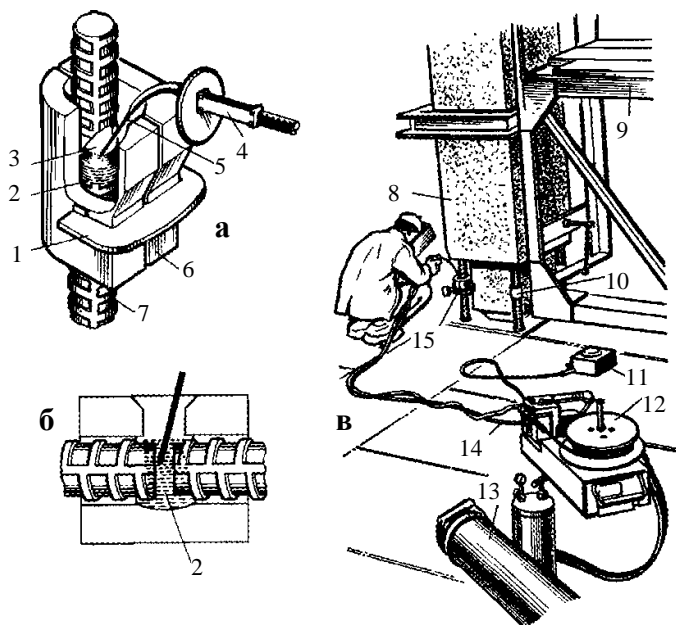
Напівавтоматичне зварювання арматури стиків: а, б – ванне зварювання вертикальних і горизонтальних стиків; в – зварювання в середовищі захисного газу; 1 – скоба; 2 – шлакова ванна; 3 – стик; 4 – тримач; 5 – електродний дріт; 6 – напівформи; 7 – арматура; 8 – колона; 9 – кондуктор; 10 – зварений стик; 11 – реостат; 12 – котушка зі зварним дротом; 13 – балон з газом; 14 – шланг; 15 – зварний стик
